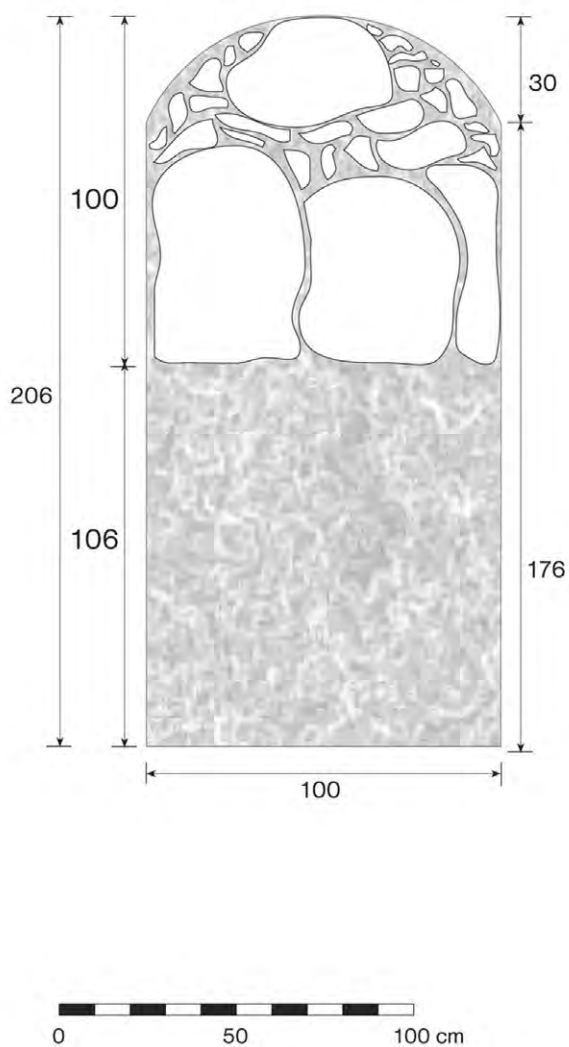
Prerez podzemnega hodnika pod cesto v Vincarje (risba I. Kraševac). / A cross section of the underground passage under the road to Vincarje (drawing by I. Kraševac).
